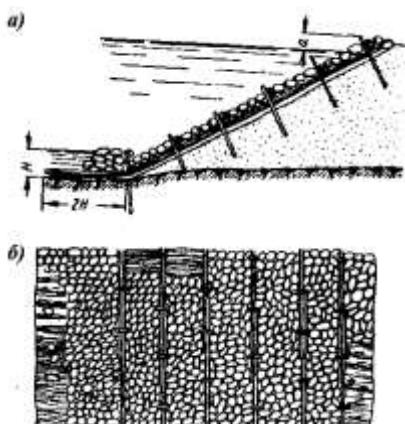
Плетевые клетки с каменной наброской; а – поперечный разрез; б – вид сверху
